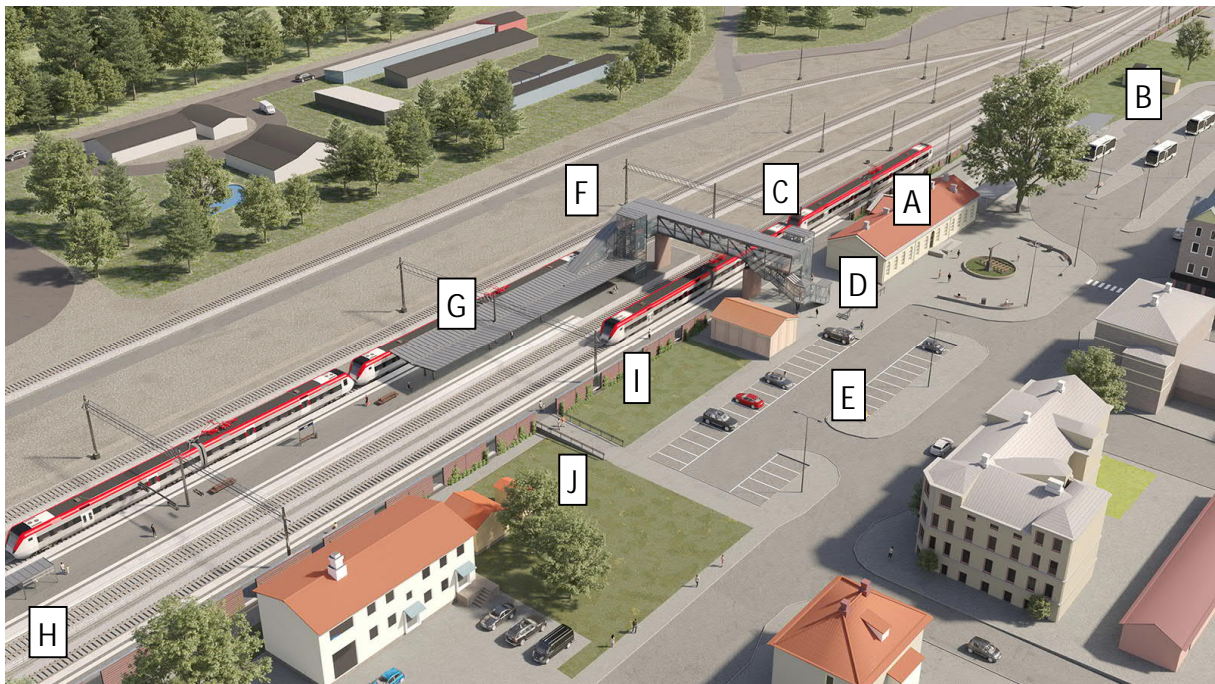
Plan över framtida stationsområde. Trafikerade plattformar är gråtonade.
